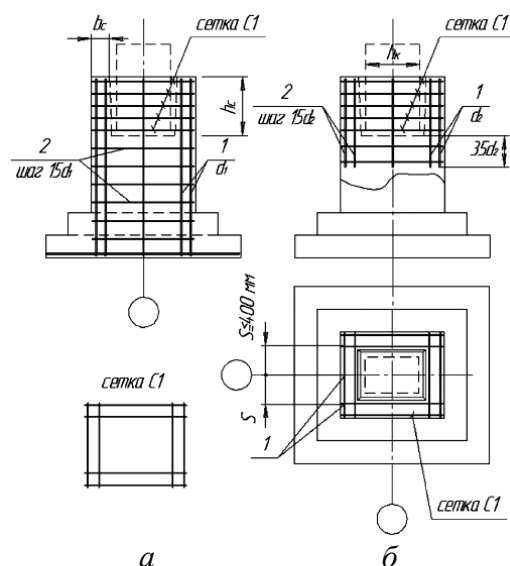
Армирование стаканной (подколонной) части монолитного столбчатого фундамента: *а* – ж/б подколонник; *б* – бетонный подколонник, 1, 2 – продольная и поперечная арматуры
